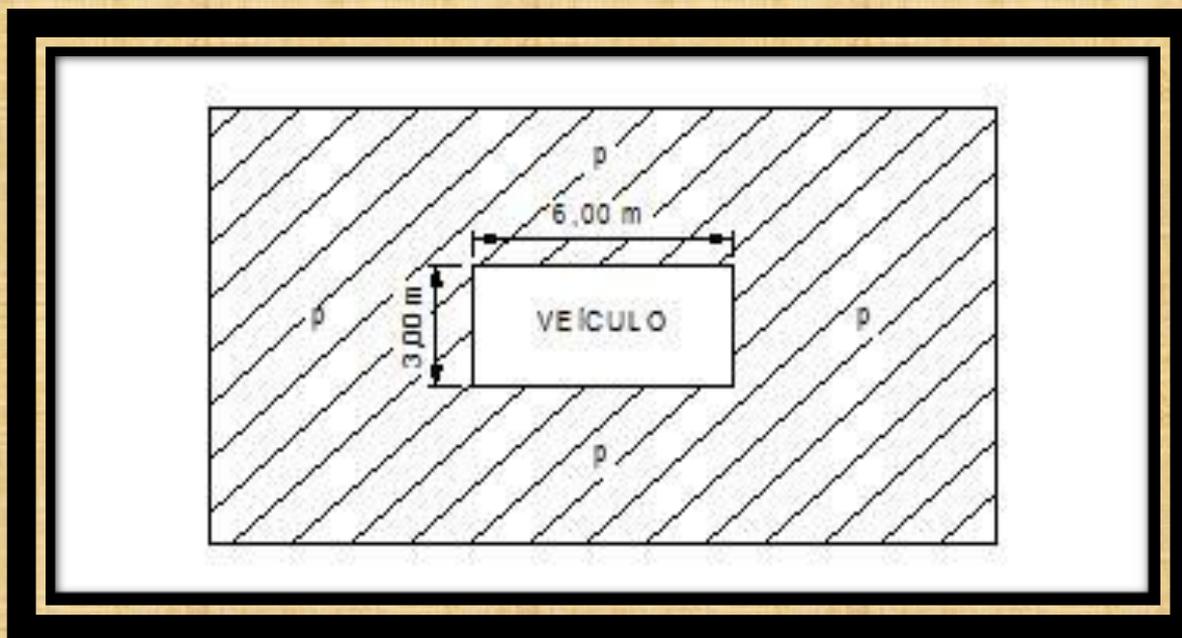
Veículo e multidão em planta (ABNT, 1984)
